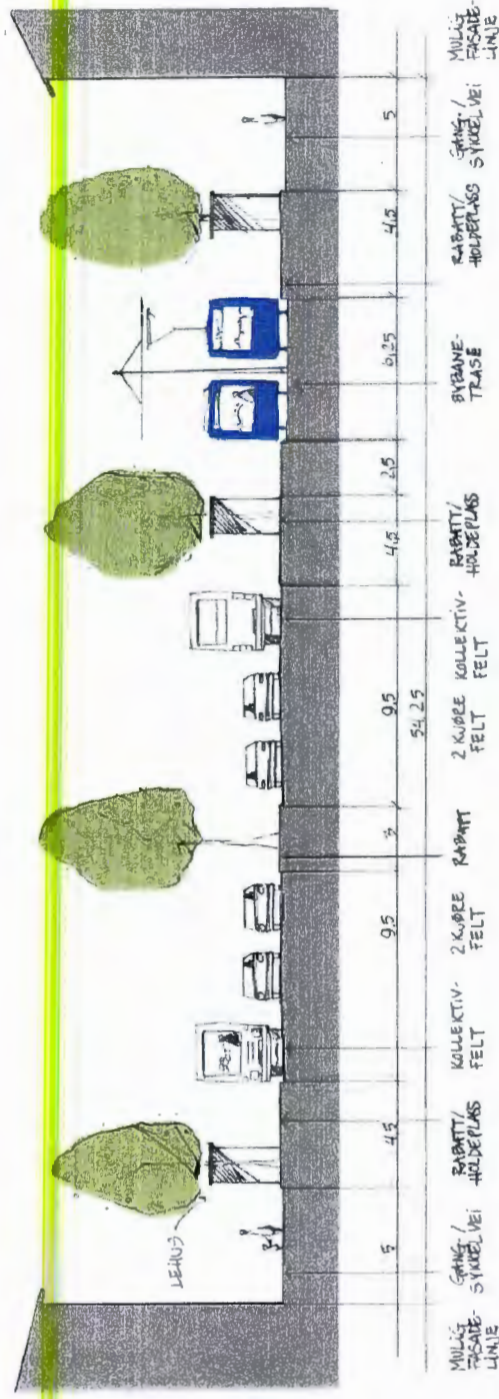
Illustrasjonsplan Lysaker Terminal, Alt. 1
